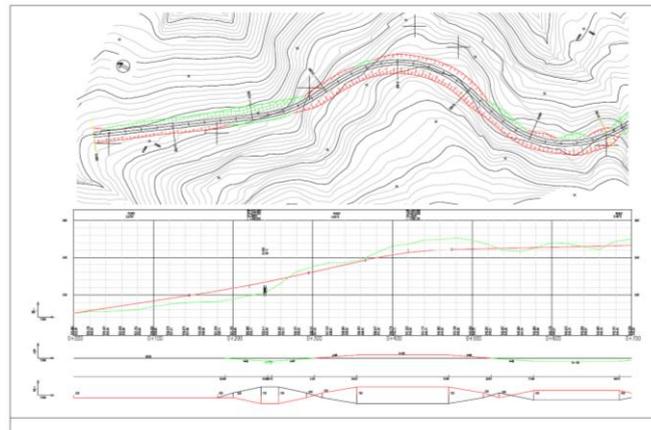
Plano de planta y alzado (programa CLIP de TOOL, S.A.)
